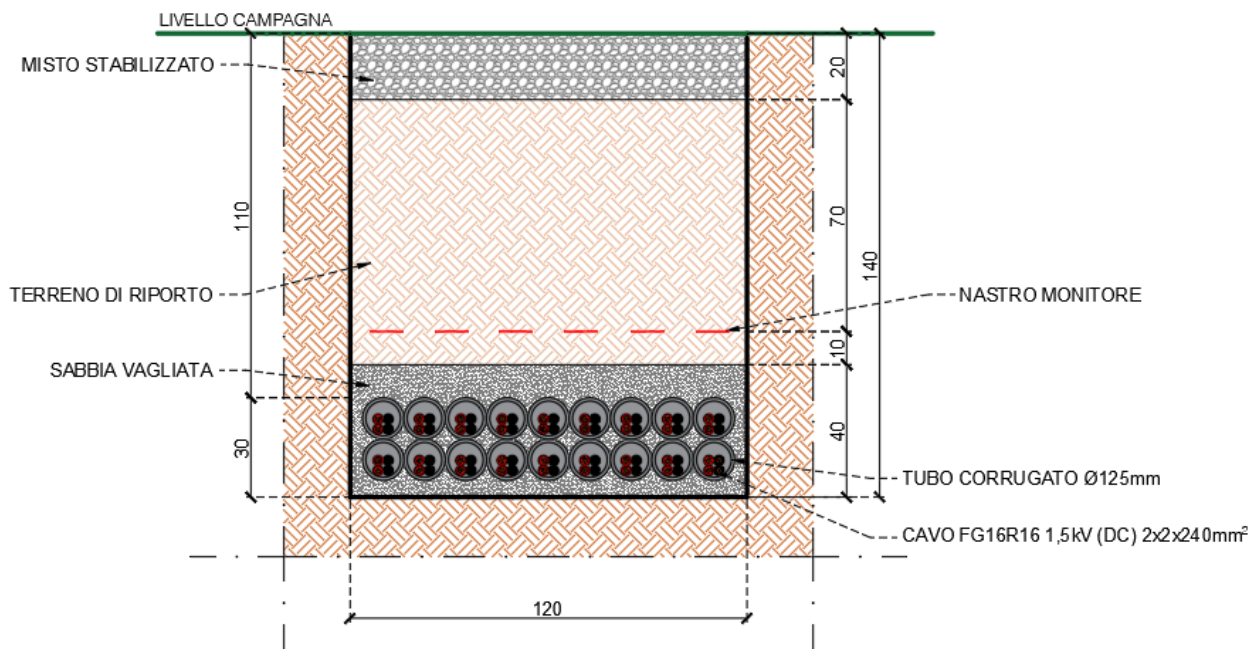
Sezione di scavo cavidotto BT DC (18 linee)
